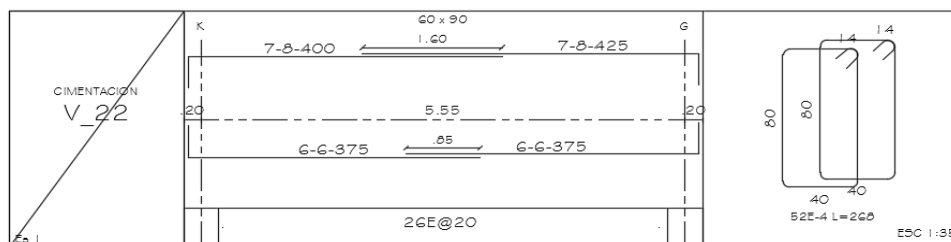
Despiece de viga de cimentación sentido numeral.
